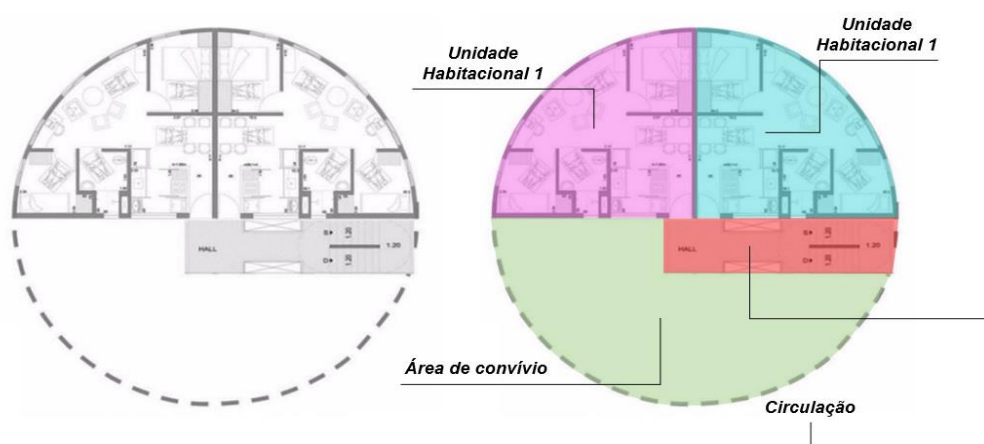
Planta do pavimento térreo do Conjunto residencial Heliópolis I.
